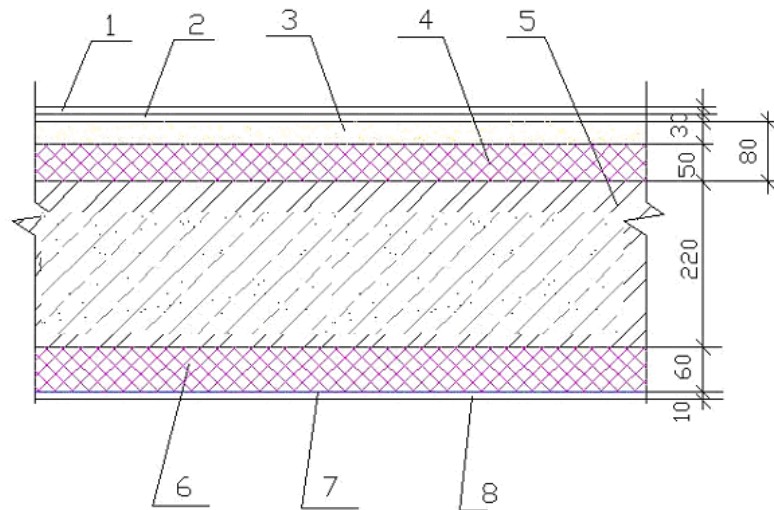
Підлога жилих приміщень: 1 – покриття підлоги з лінолеуму чи ламінату; 2 – прошарок з швидкотвердіючої мастики на водостійких в'язучих; 3 – стяжка з цементно-піщаного розчину марки М150; 4 – теплоізоляційний шар — STROPROCK; 5 – залізобетонна плита перекриття; 6 – теплоізоляційний шар — STROPROCK; 7 – паробар'єр – Ютафол Н110 стандарт; 8 – зашивка
